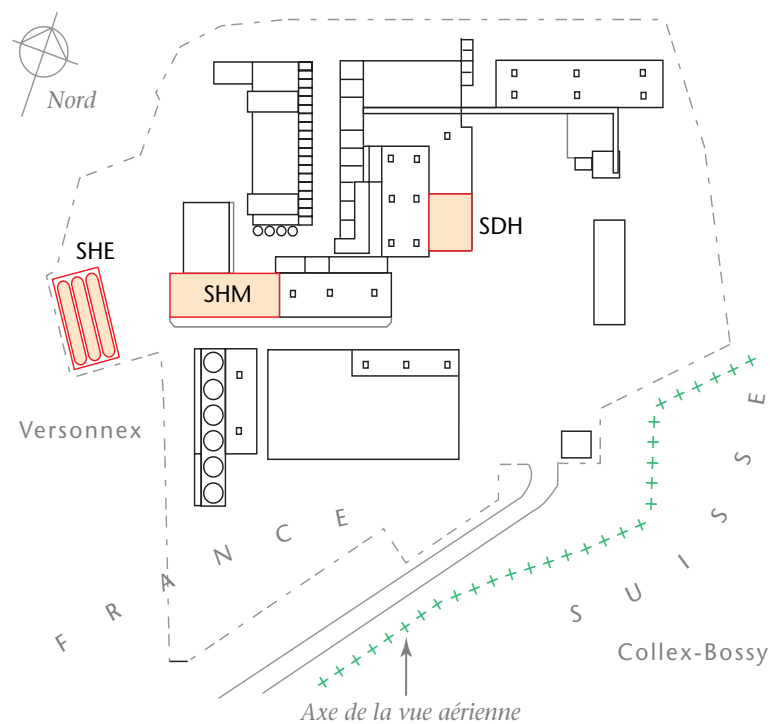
Plan de masse des ouvrages de surface au Point 6
